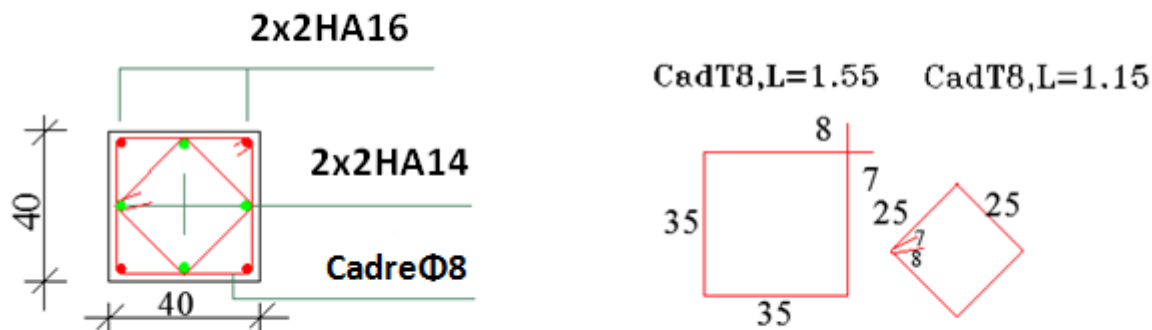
Disposition des armatures dans les poteaux (40x40)
